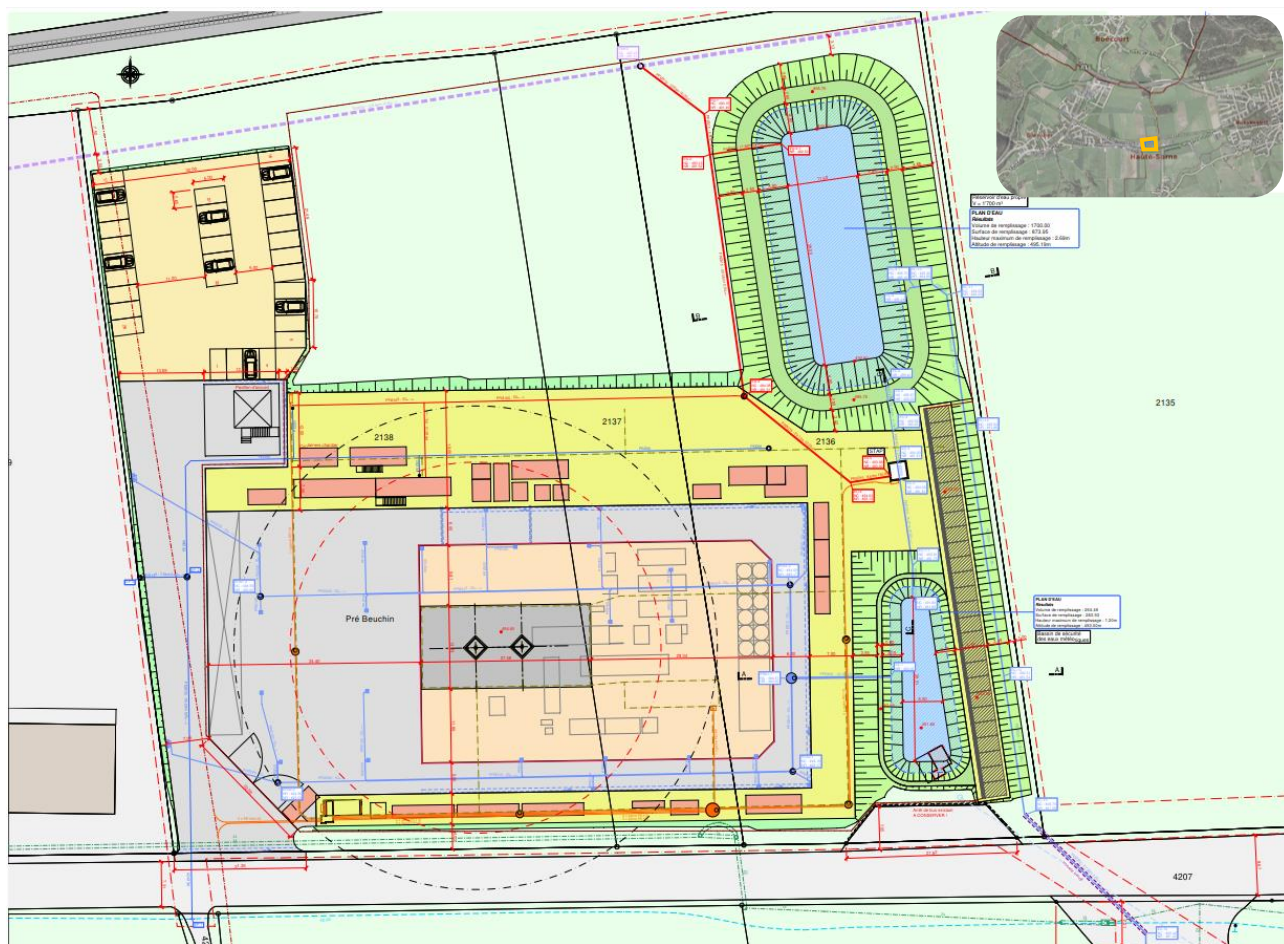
Plan de situation de la place de forage et situation du chantier (Sources : GES et Géoportail JU)
